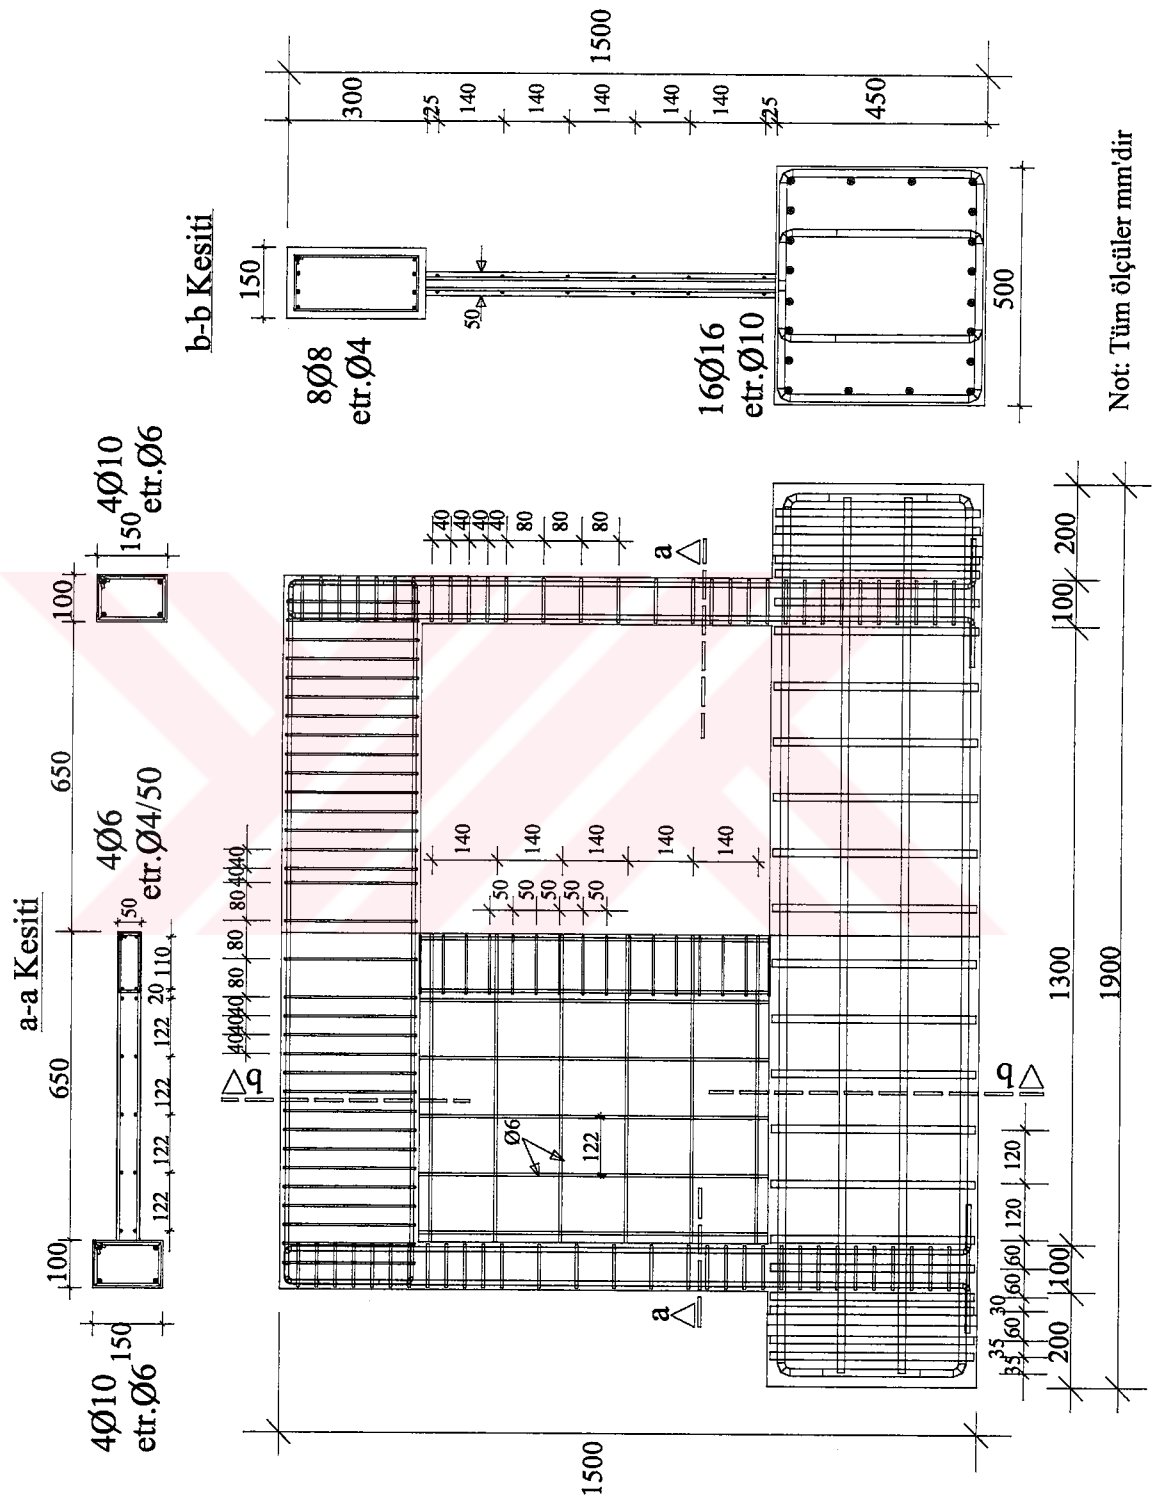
Deney Elemanı-2'nin donatı detayı
